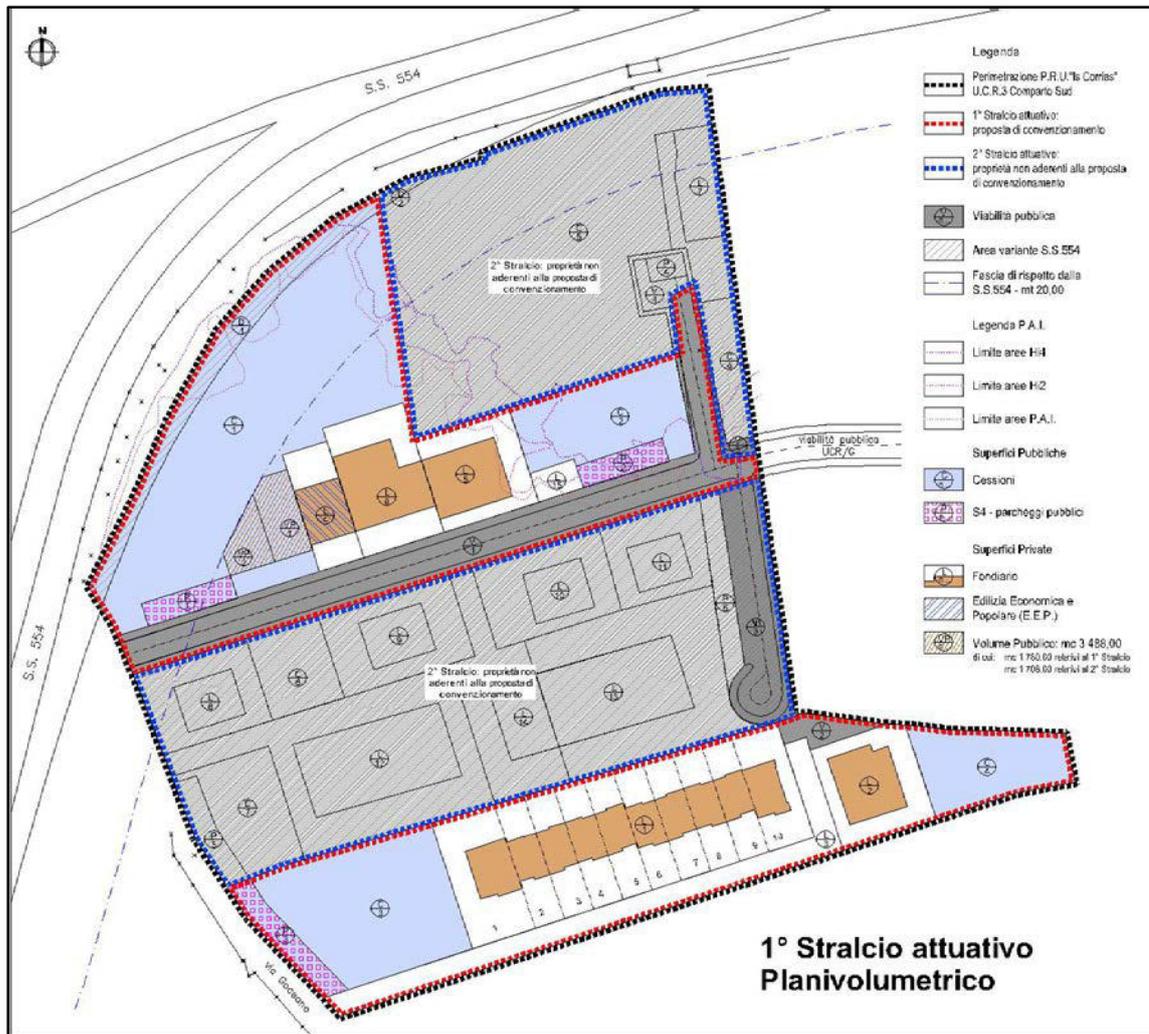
Planivolumetrico di progetto - 1° Stralcio Funzionale
